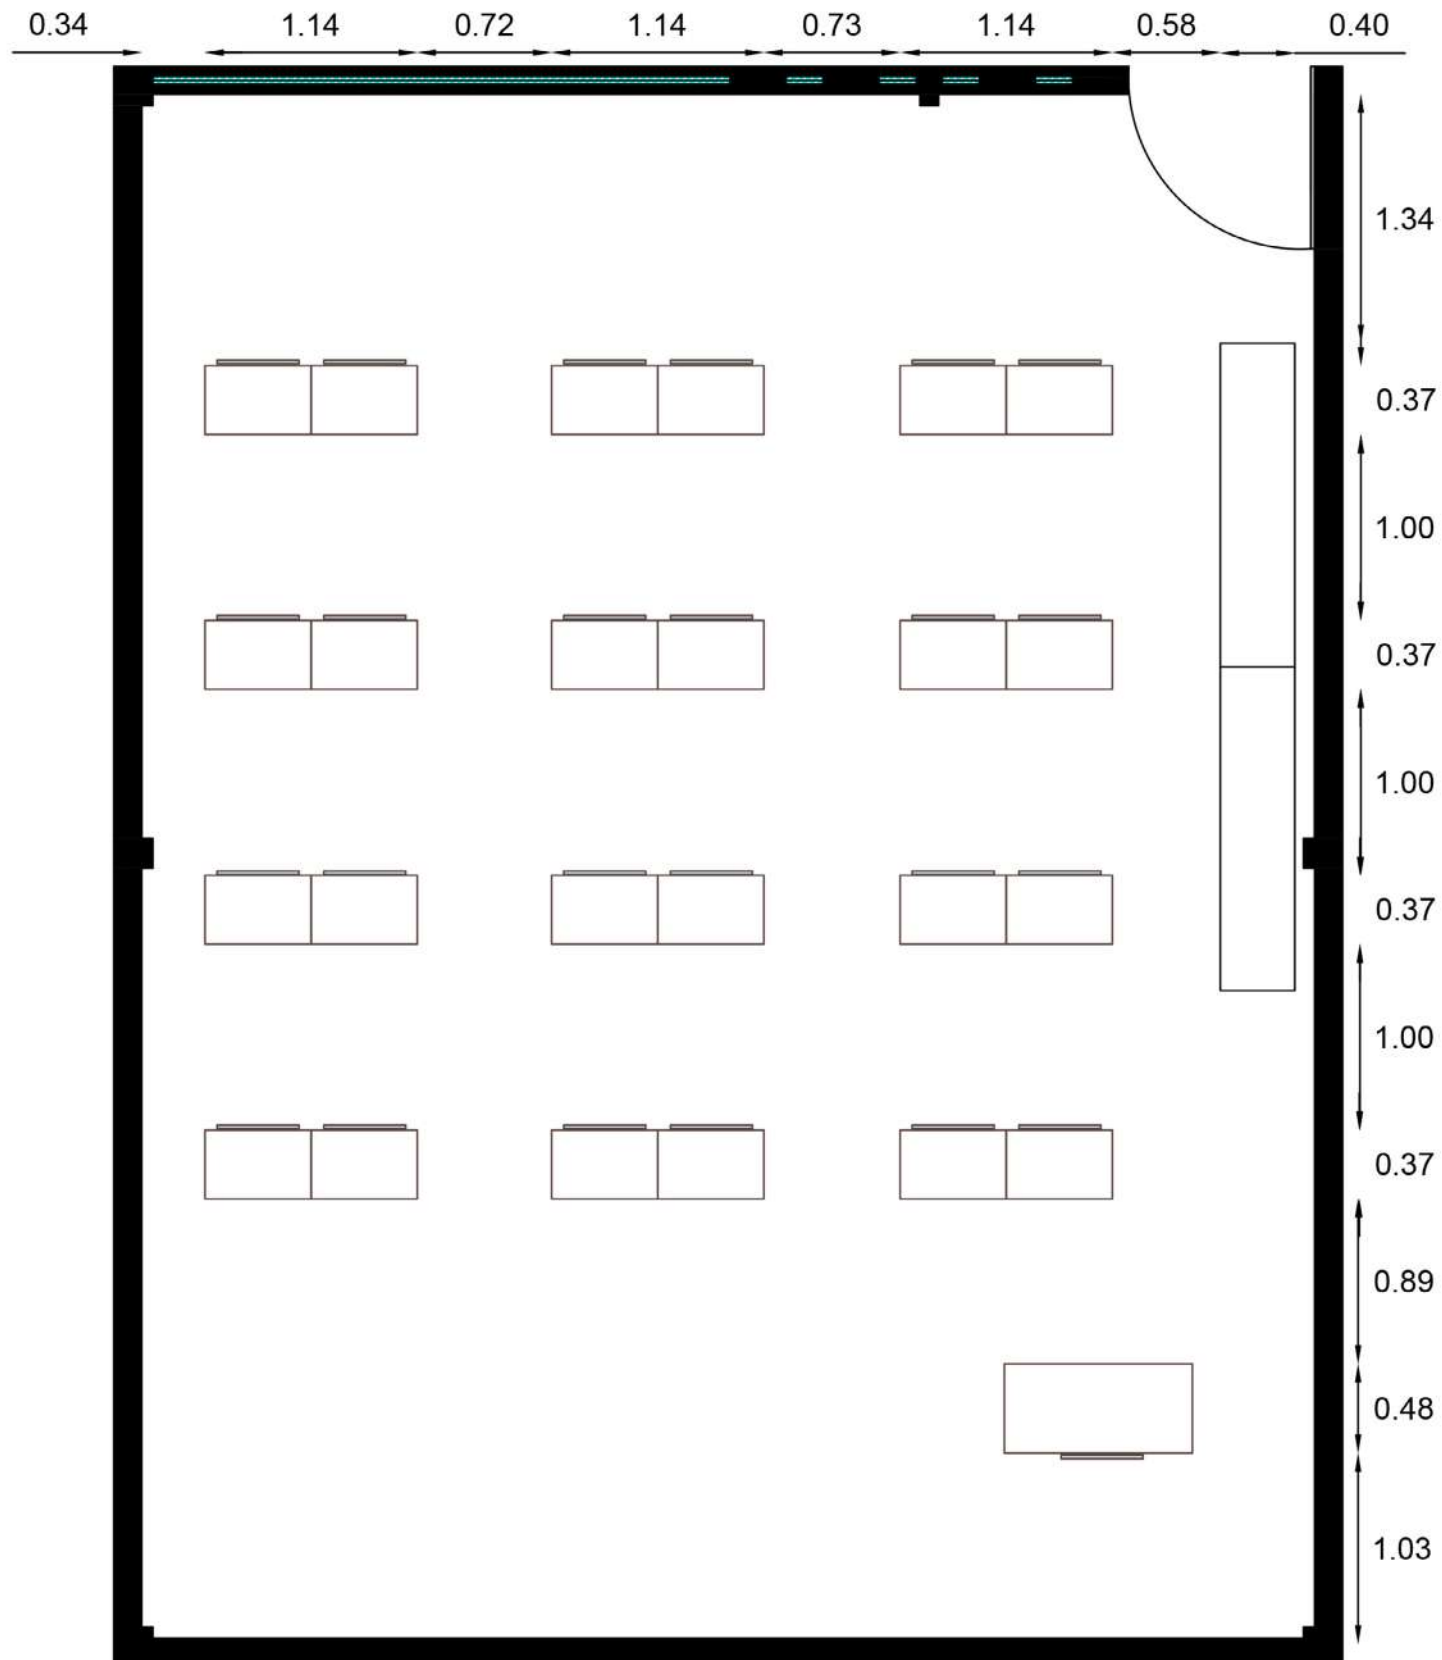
Planta arquitectónica de distribución de mobiliario ESC 1.50.
